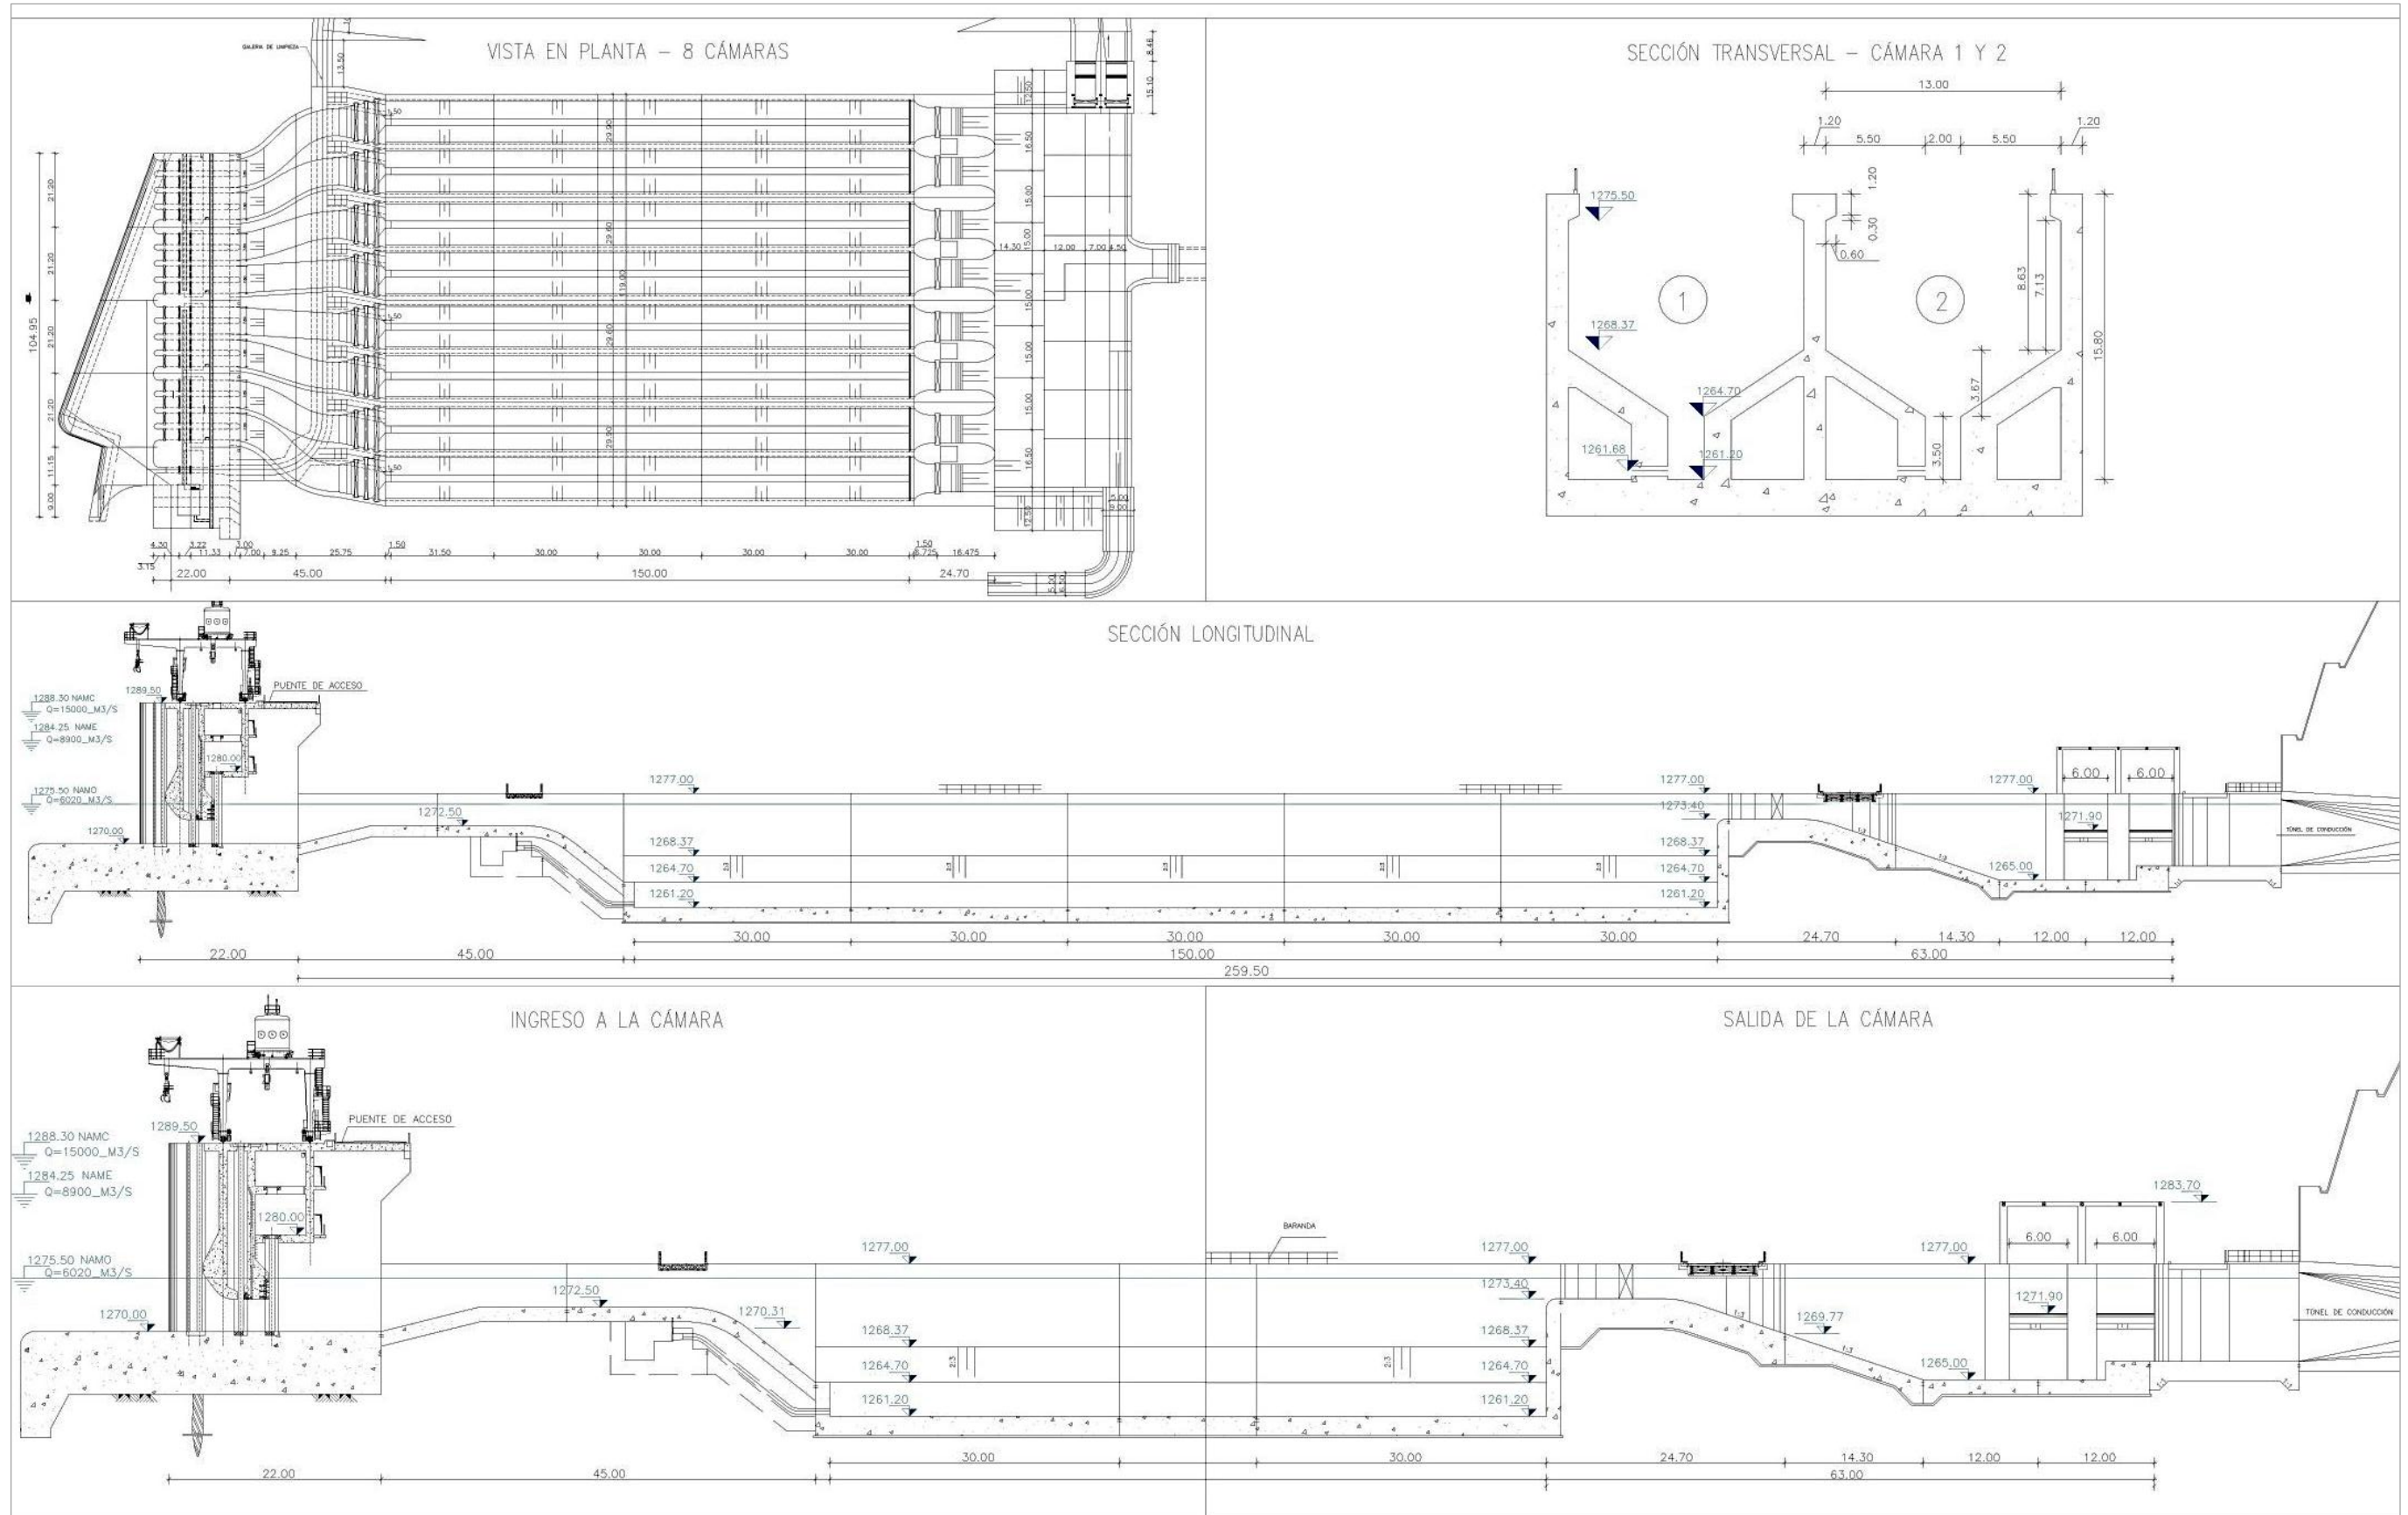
Vista en planta y sección longitudinal del prototipo del desarenador
